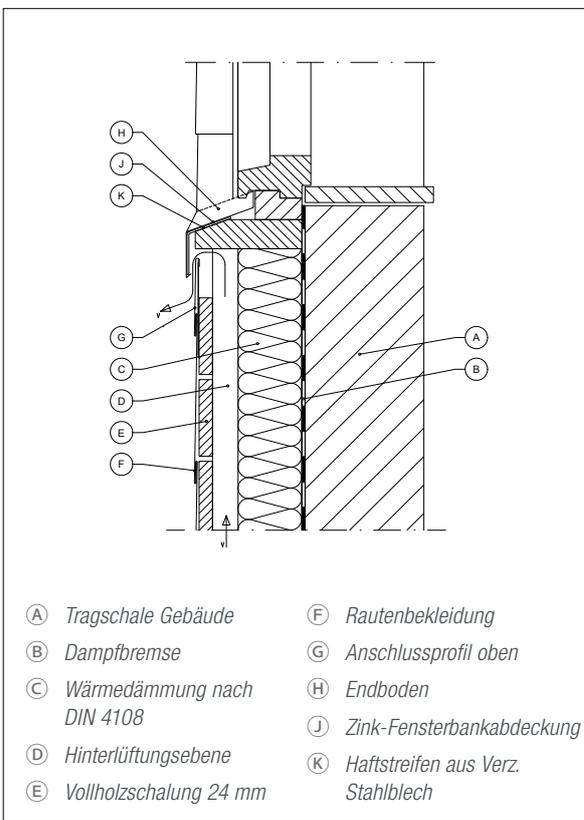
Rautensystem Unterer Fassadenanschluss
